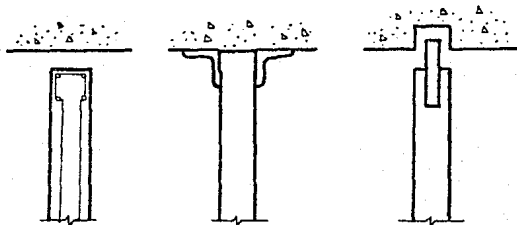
Alternativas para desligar los muros de la estructura en elevación.
